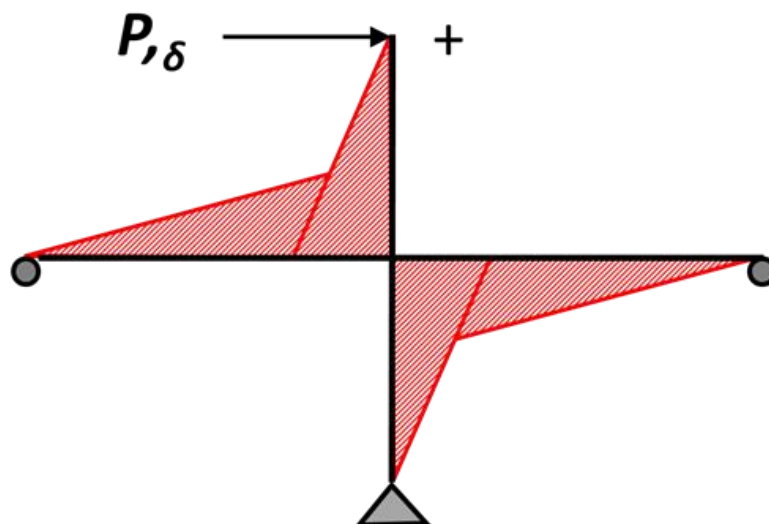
Zonas de tracción en la fase de carga sobre columnas y vigas en el ensayo 2.
